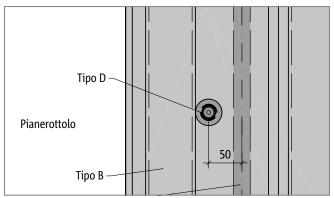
Schöck Tronsole® tipo B + tipo D: Dettaglio A
